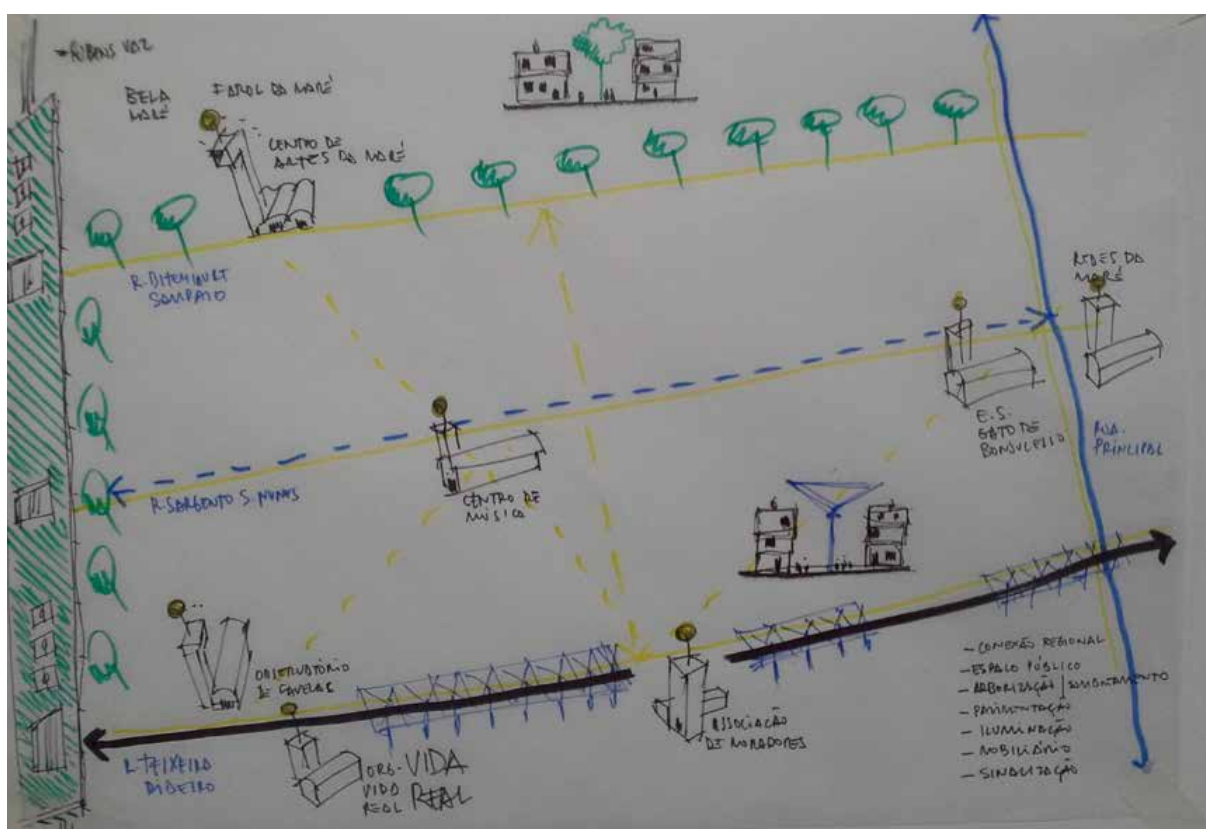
Proposta Arquiteto Pedro Évora (Foto: Sonia Lopes)
